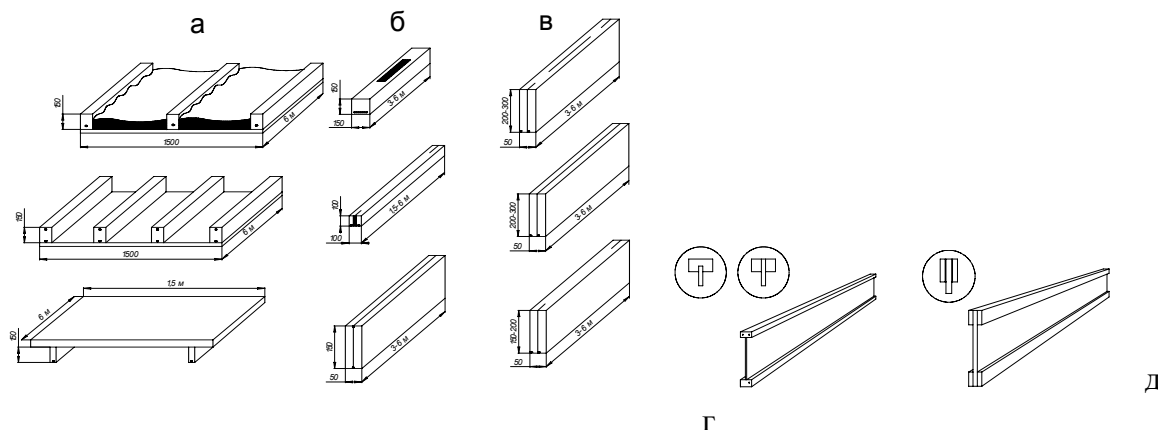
Балки и спецзаготовки для каркасных конструкций: а – армированные сборно-клееные элементы каркасов; б- двутавровые балки на основе ЛВЛ; в- сборно-клееные балки каркаса из фанеры и заготовок цельной древесины
